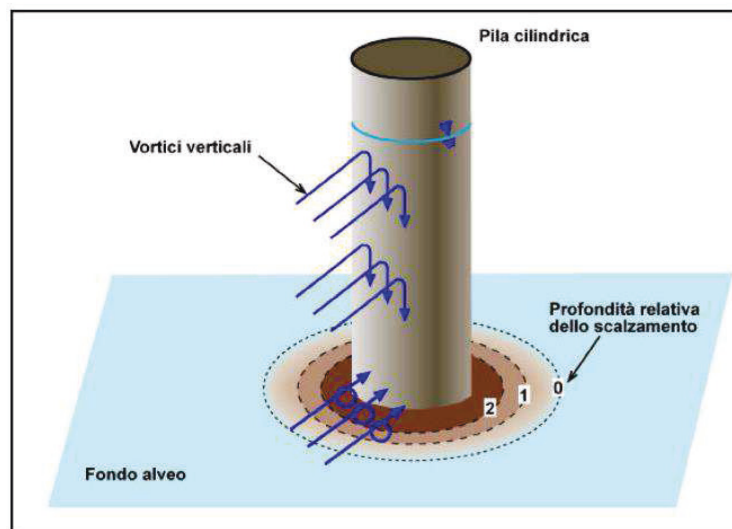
Schema del fenomeno dello scalzamento locale dovuto alla pila
